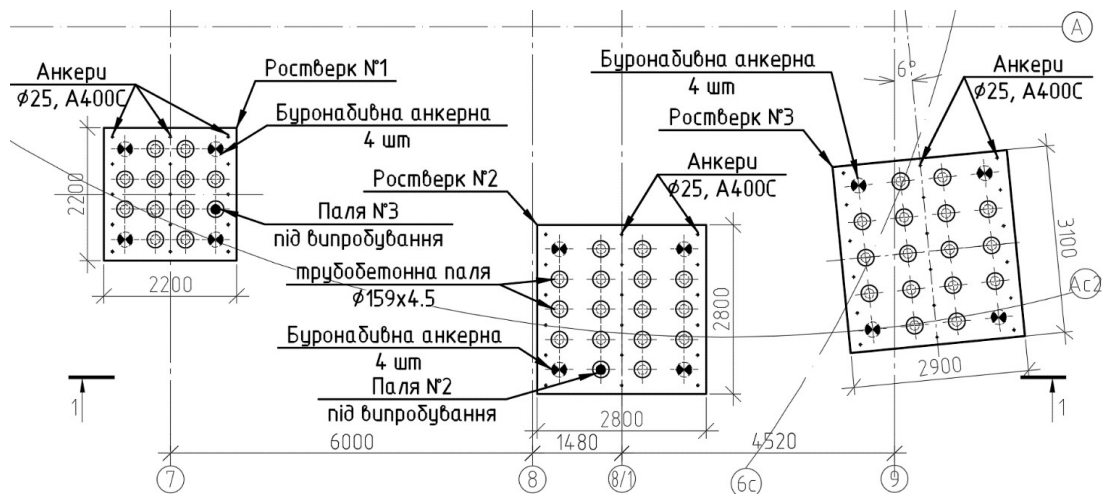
Схема фундаментів під прибудовану частину будівлі
